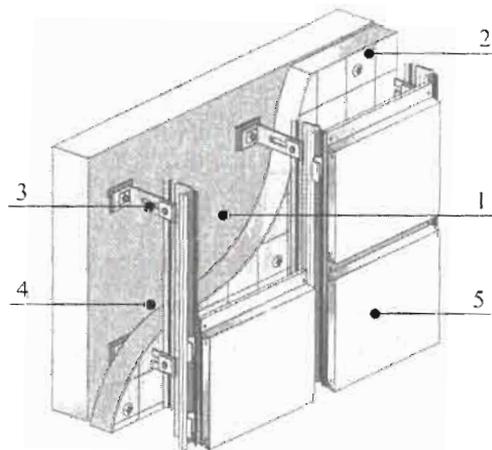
Конструкция навесного вентилируемого фасада:
